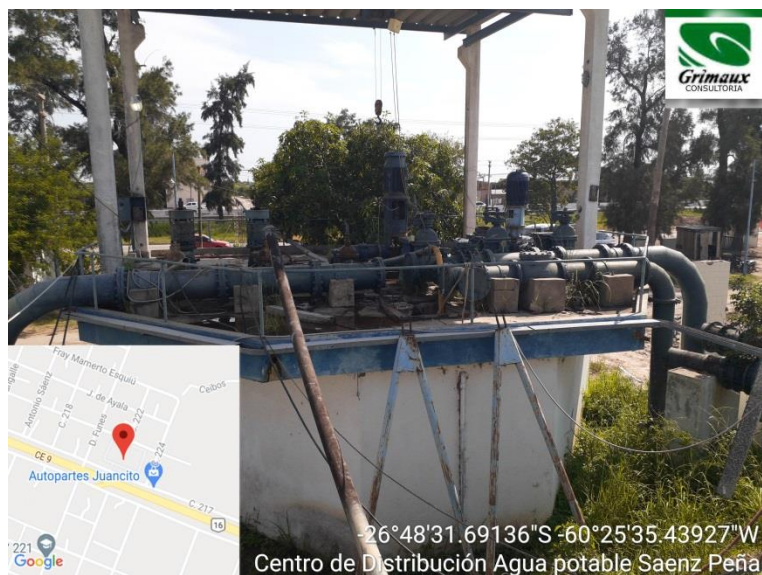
Instalaciones Centro de Distribución. Fuente: propia.
